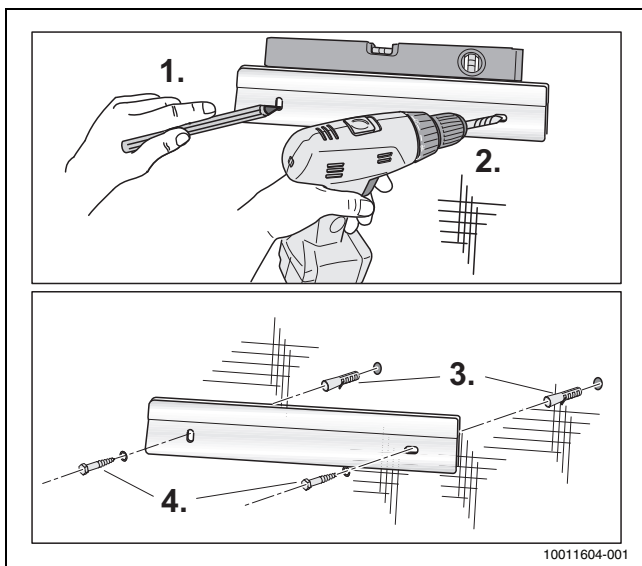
Instalar o suporte de fixação numa parede de cimento
